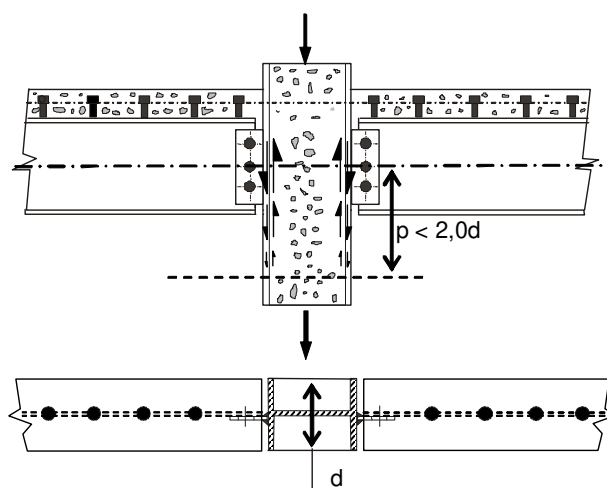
Transferência de forças em uma ligação típica viga-pilar.
